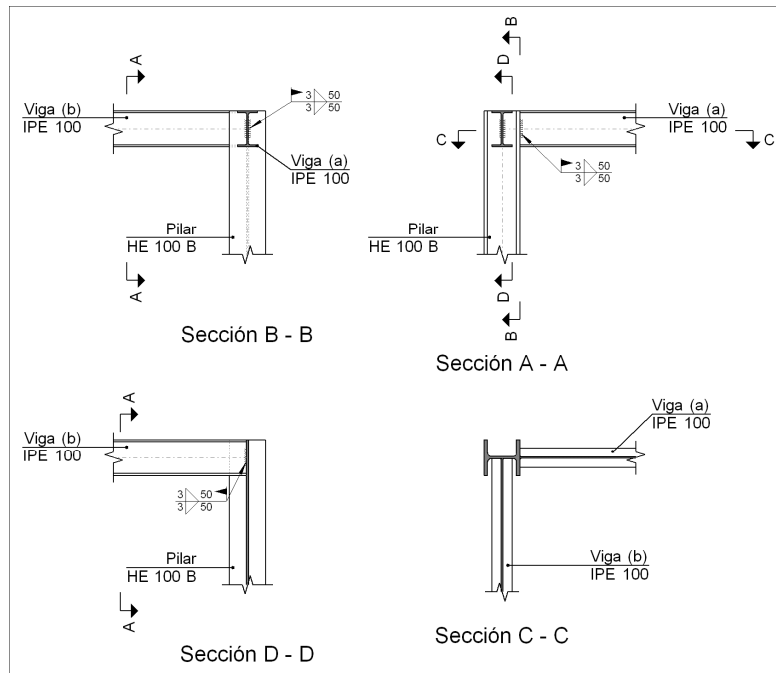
Detalle de las soldaduras tipo 5 de la estructura superior de las escaleras
